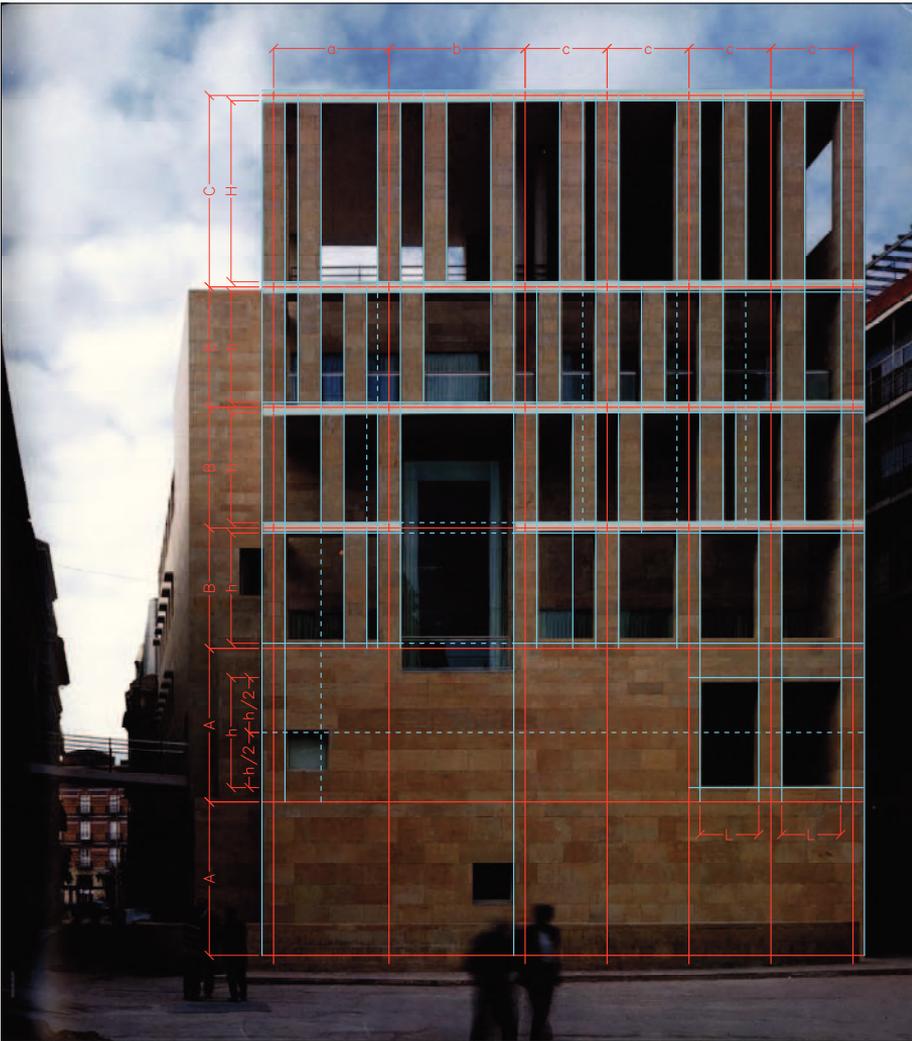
Municipio di Murcia, prospetto su piazza Belluga con individuazione del sistema di modulazione.
